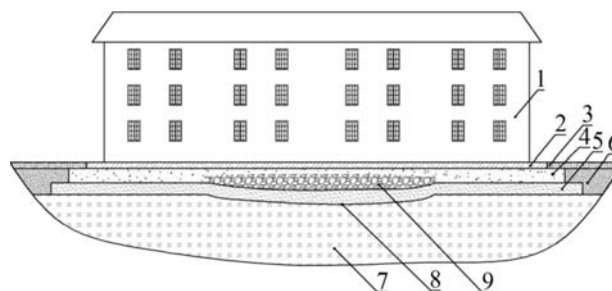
Схема работы трехслойного сплошного плитного фундамента при просадке подработанных грунтов под зданием:
